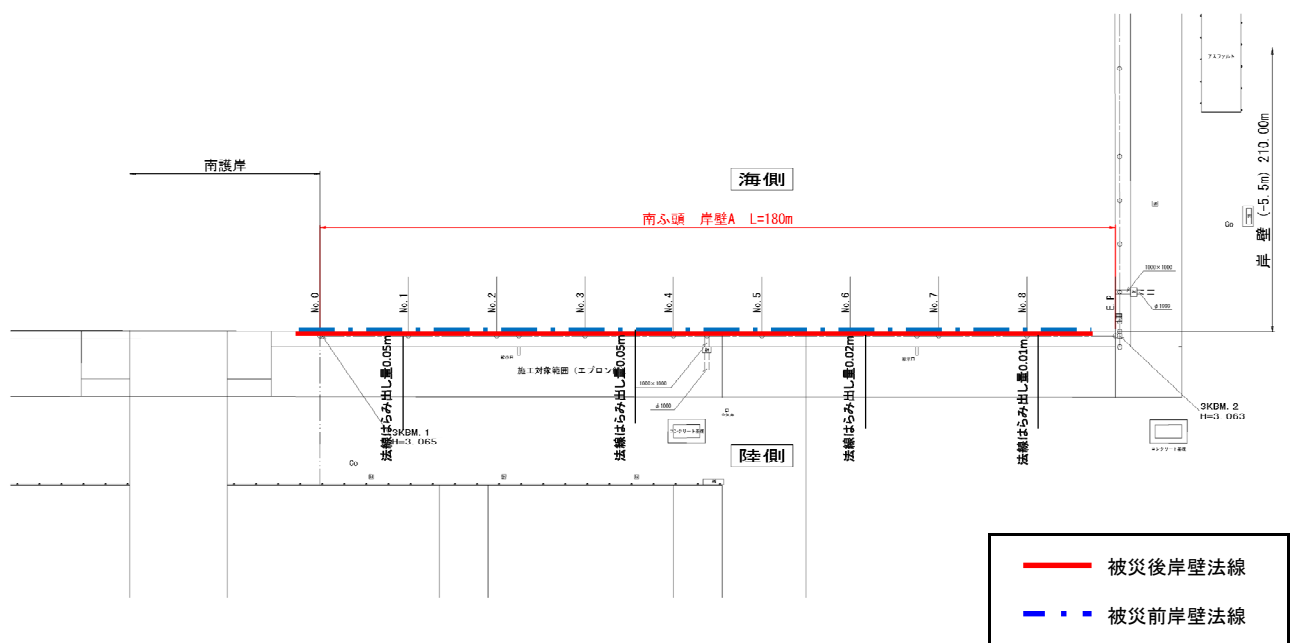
No.21 常陸那珂港区\_南ふ頭地区 A 岸壁 (-5.5m) の平面図 (被災後)
